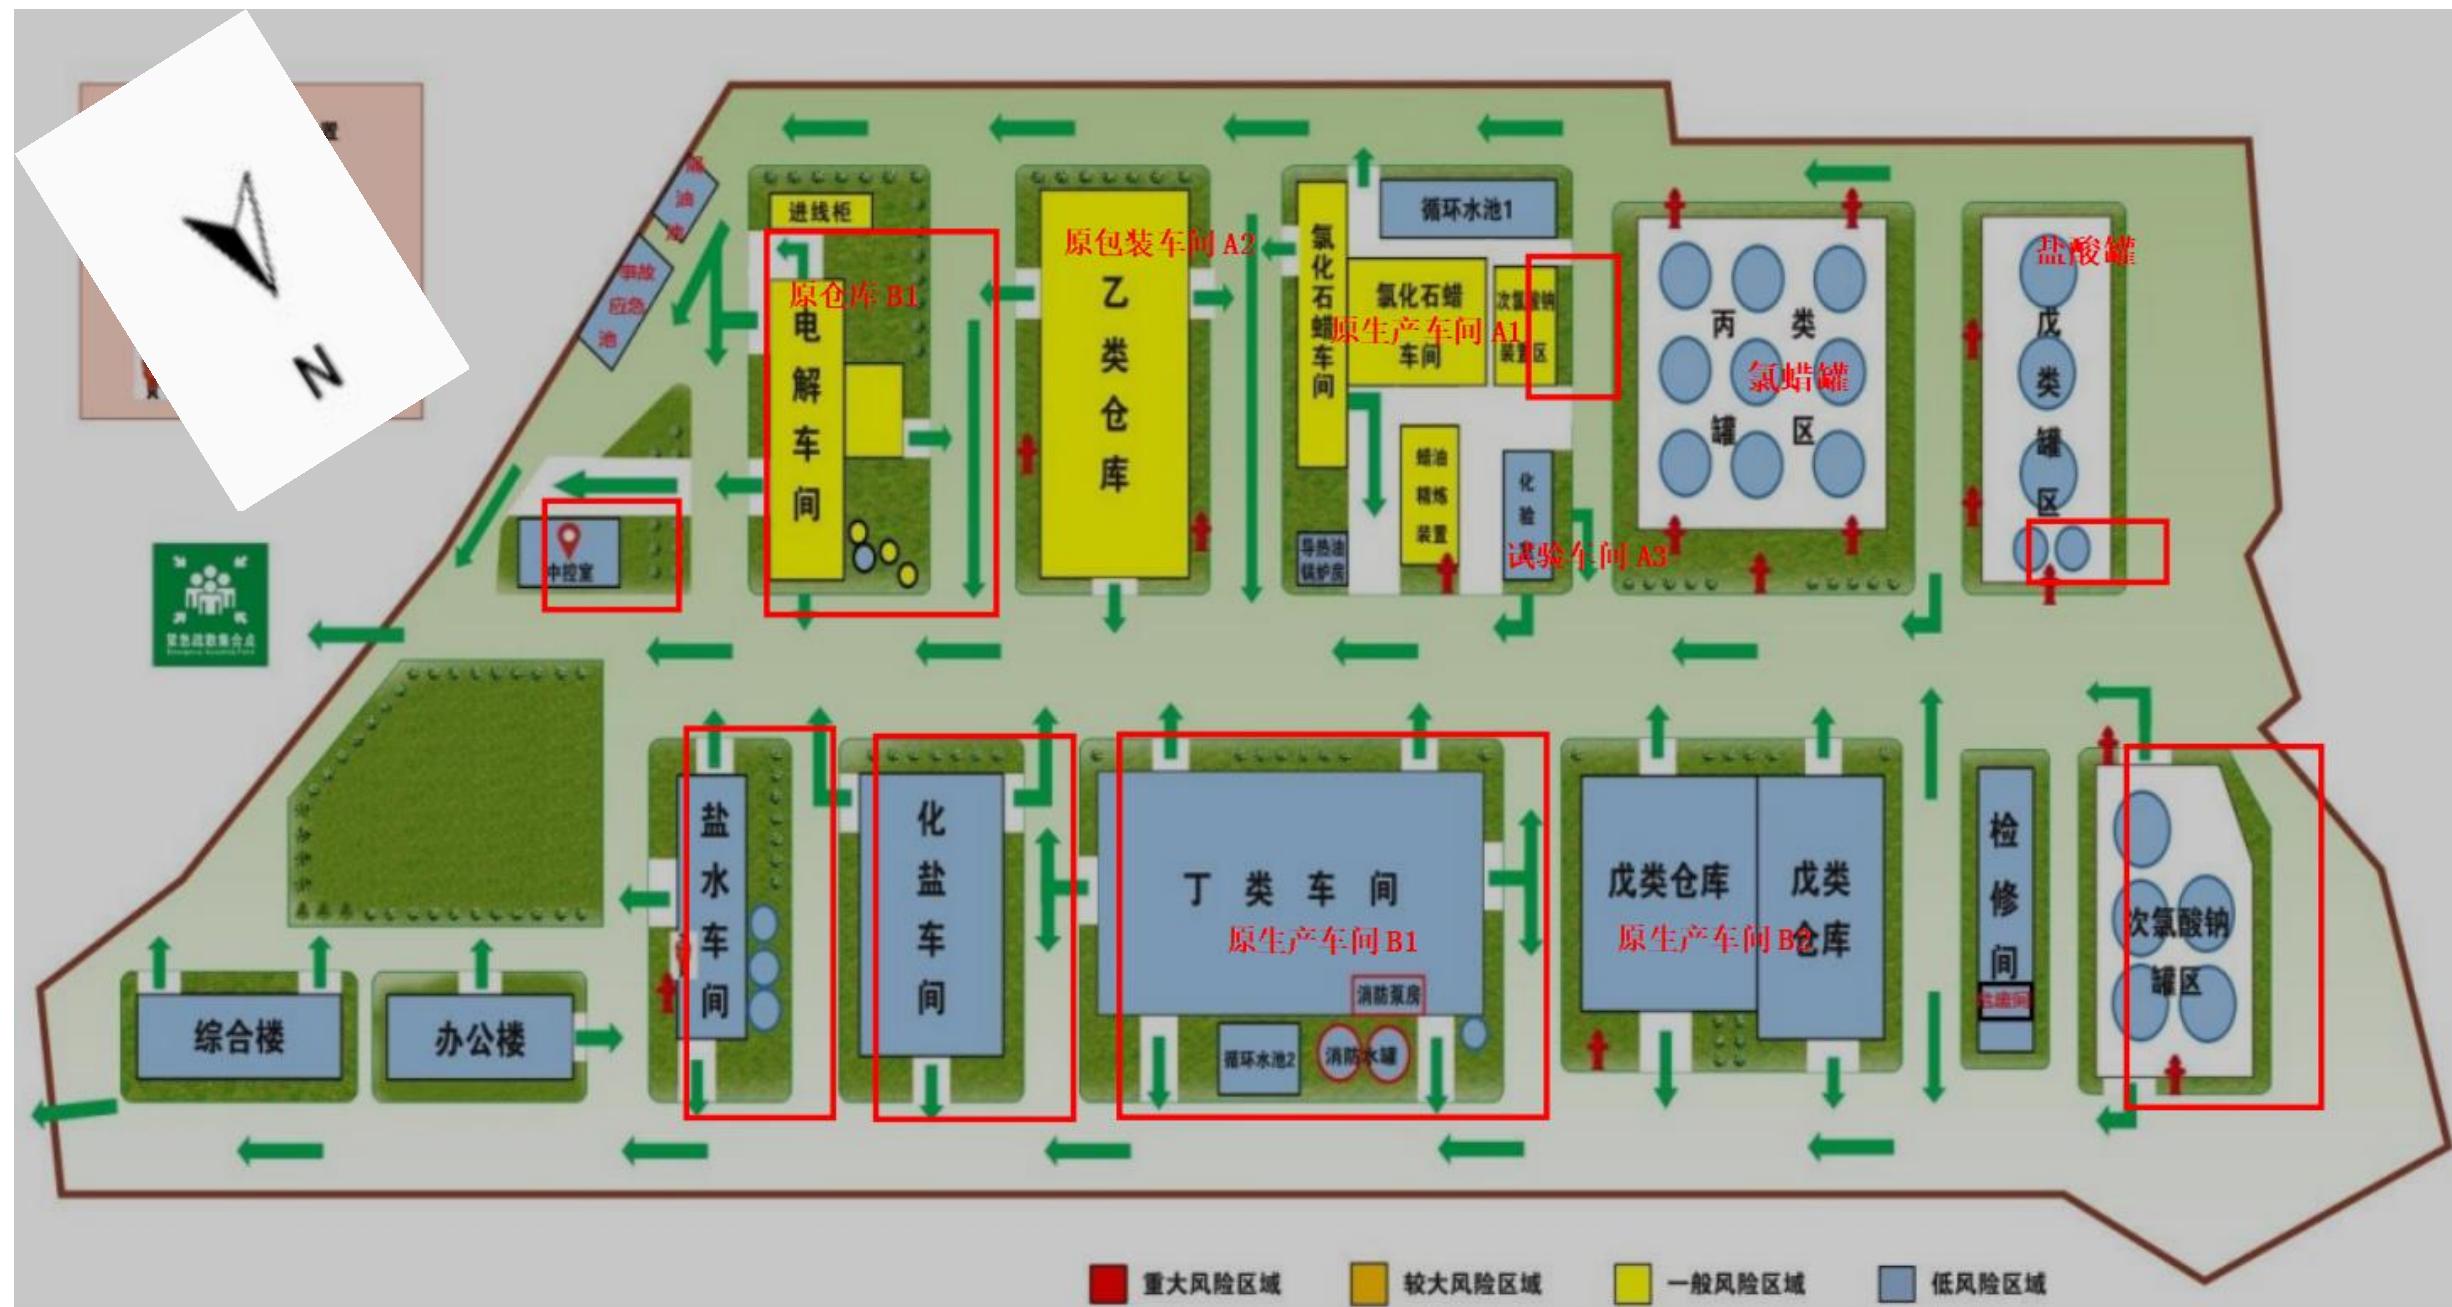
年产 15 万吨次氯酸钠项目平面布置图
